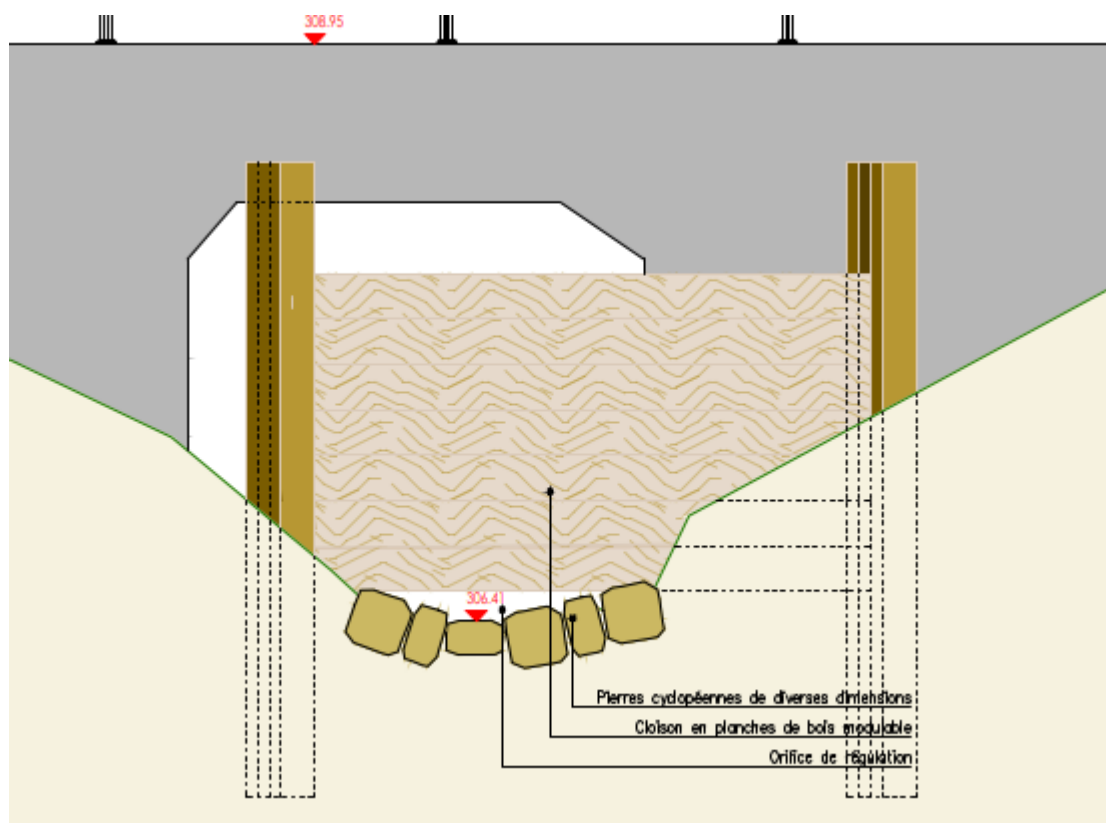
Auszug aus dem veralteten Plan „Concept d'assainissement - Vues en plan et coupes ouvrages“ (Quelle: Luxplan S.A. Stand 06/2020): Querschnitt durch die Ausleitung (Schnitt AA, vgl. Abb. 24)
